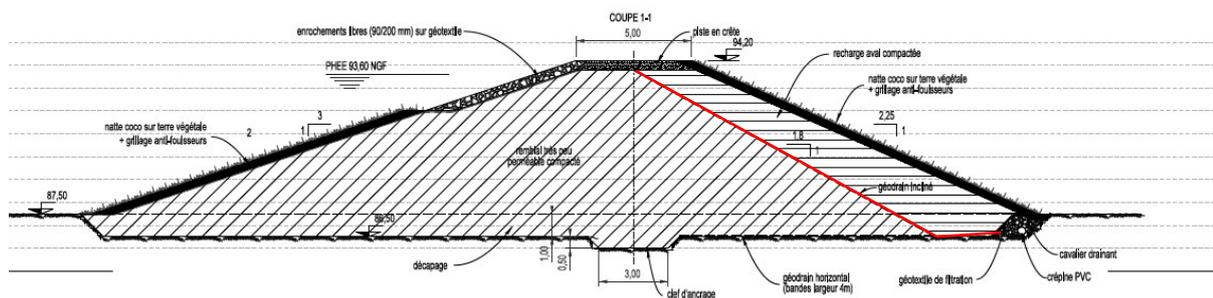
Coupe type du barrage des Arques (géodrain en rouge)
